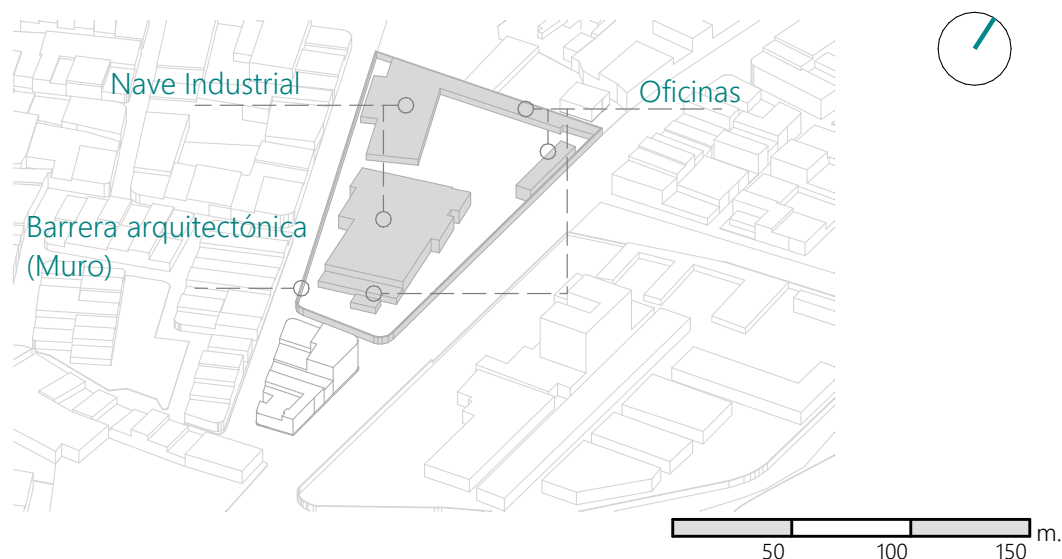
Elementos construidos en el sitio. Elaboración: Autor.
